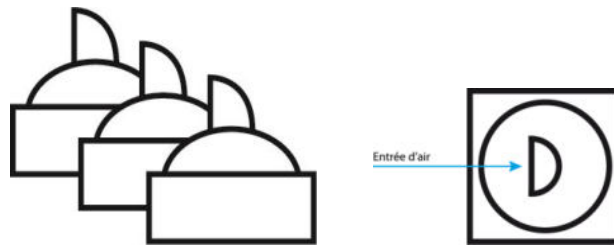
Coupe et plan du Badgir d’Afghanistan (Source : Mahyari, 1996)
